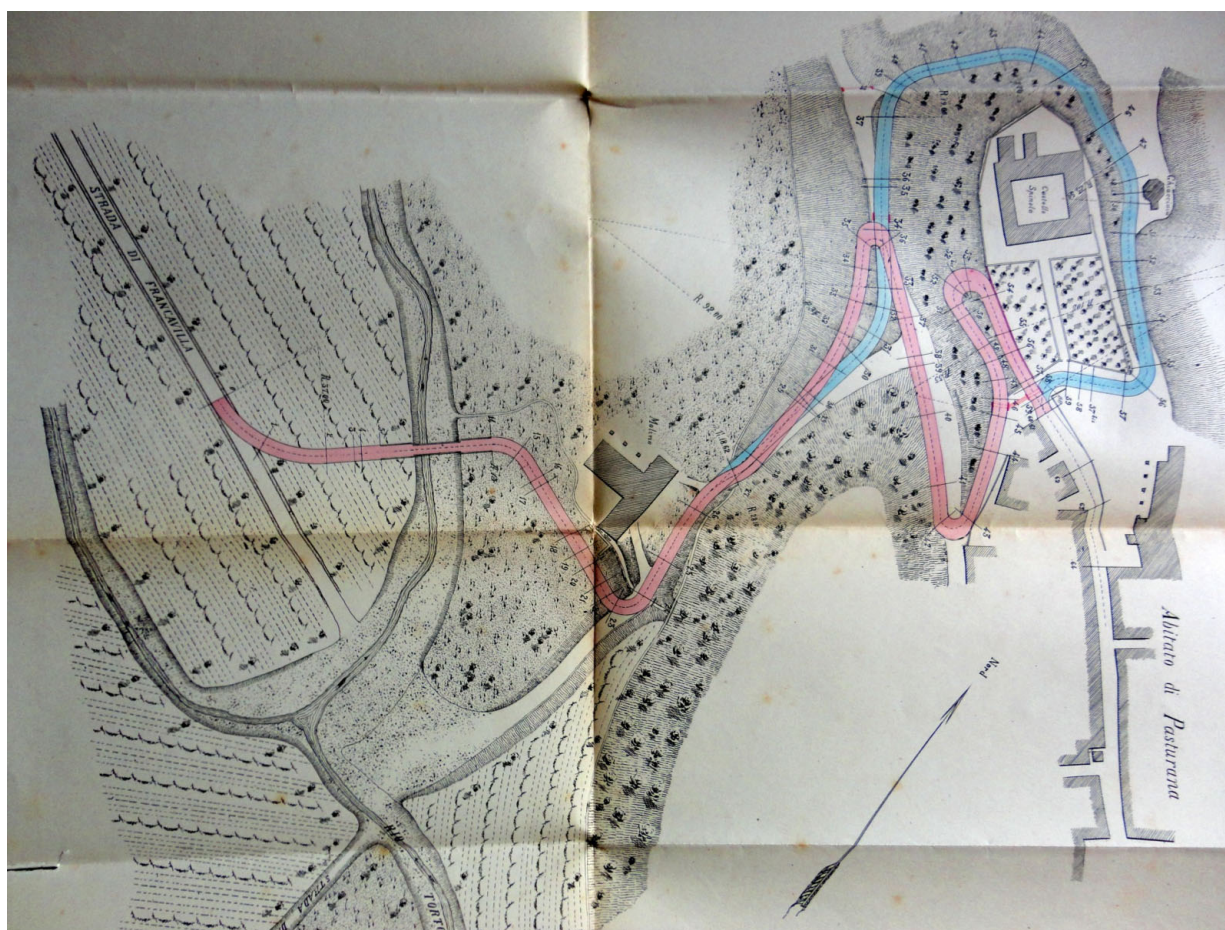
La planimetria con le sezioni numerate e lo sviluppo del progetto (a monte) in due tronchi: azzurro e rosso.
